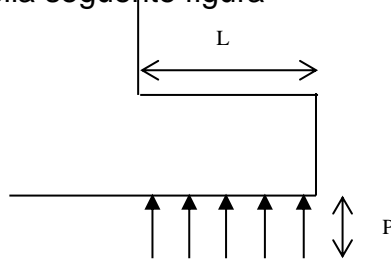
Schema di calcolo per le sollecitazioni sul plinto di fondazione
